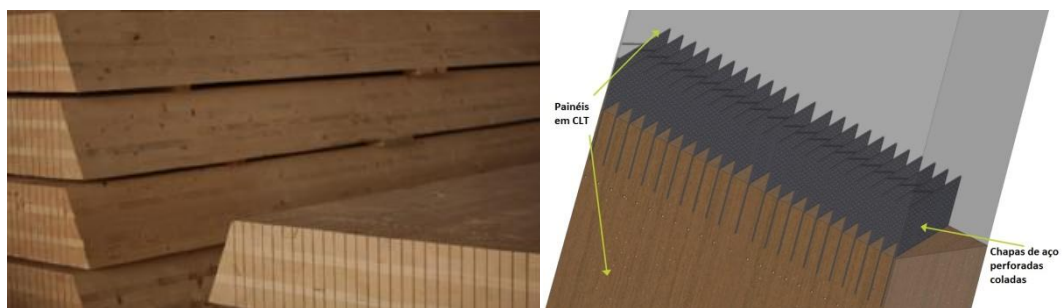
Pormenor de cortes na madeira para introdução das chapas de aço (TimberTower, 2014).
